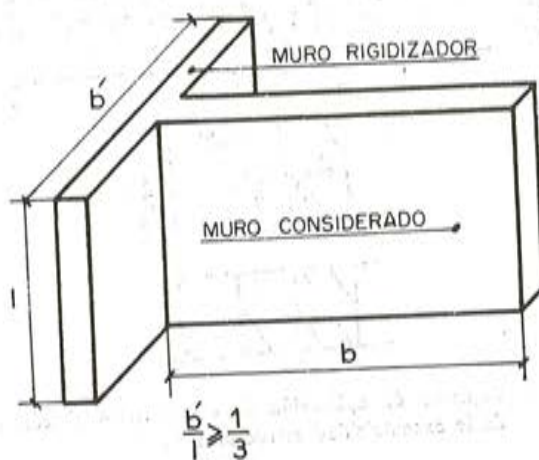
Condiciones de fijación de los bordes verticales de los paneles.
